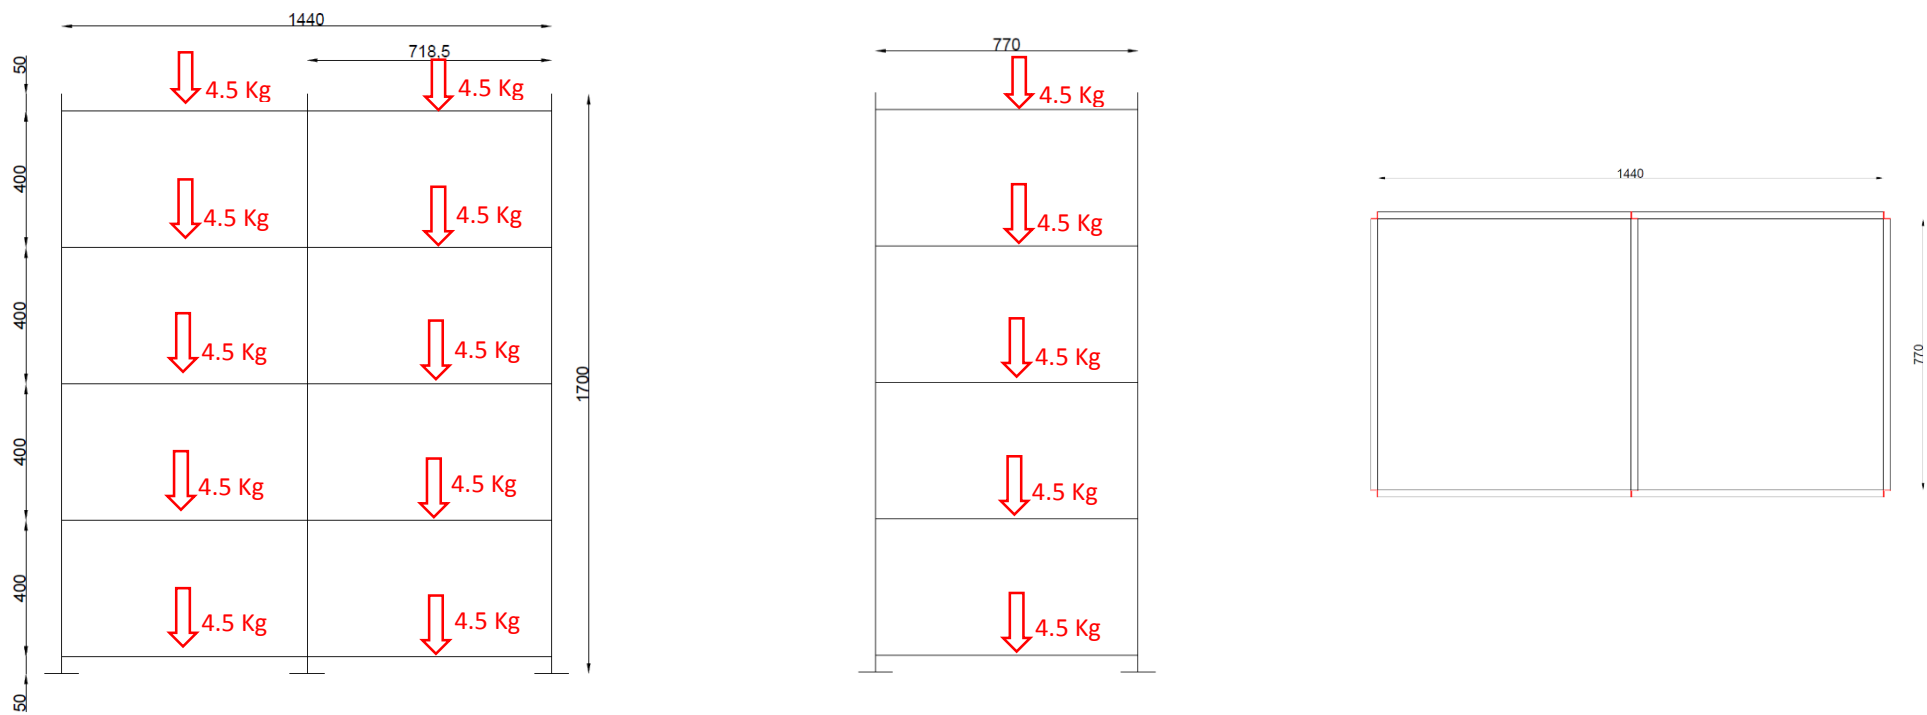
Vistas de la elevación longitudinal (izquierda), transversal (central) con las cargas añadidas y sección en planta de la estructura. Las unidades de la estructura están en milímetros.
